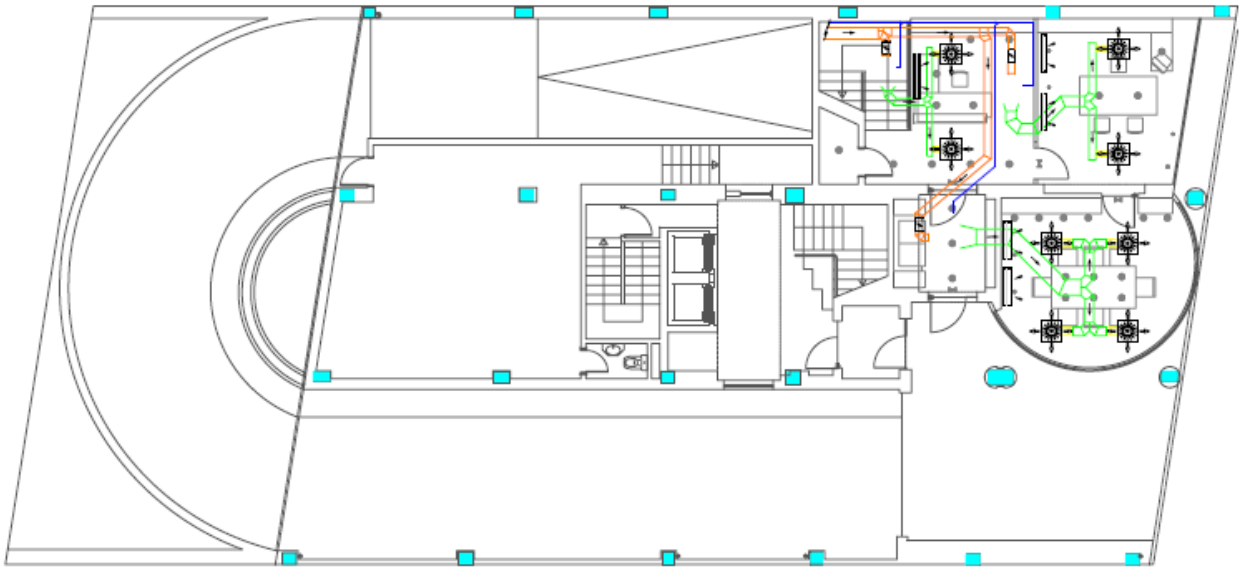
Plano Planta Baja de Oficinas Retailing One
